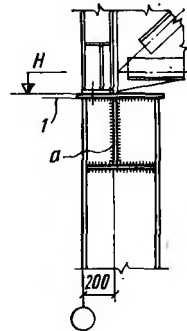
Оголовок колонны крайнего ряда бескранового здания при нулевой привязке
